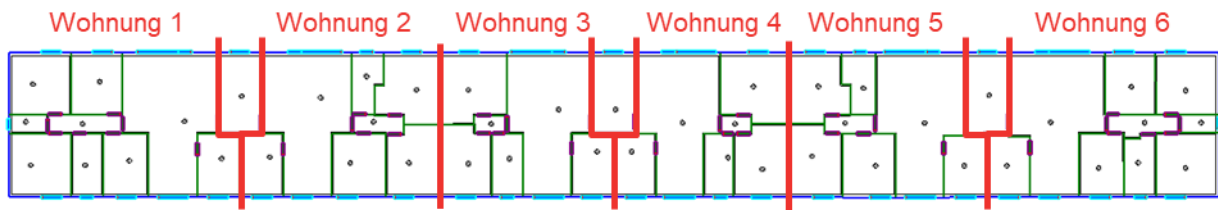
Grundriss MFH Erdgeschoss, 1. und 2. Obergeschoss, eigene Darstellung
